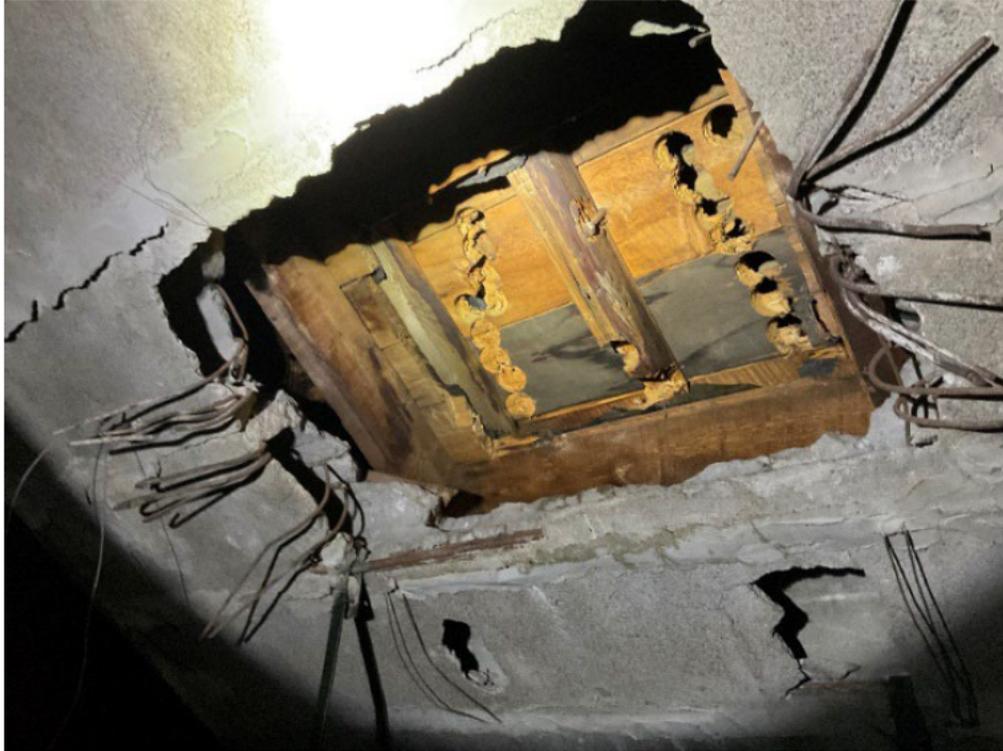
Exemple de dalles évidées de béton préfabriqué sectionnées sans renfort
